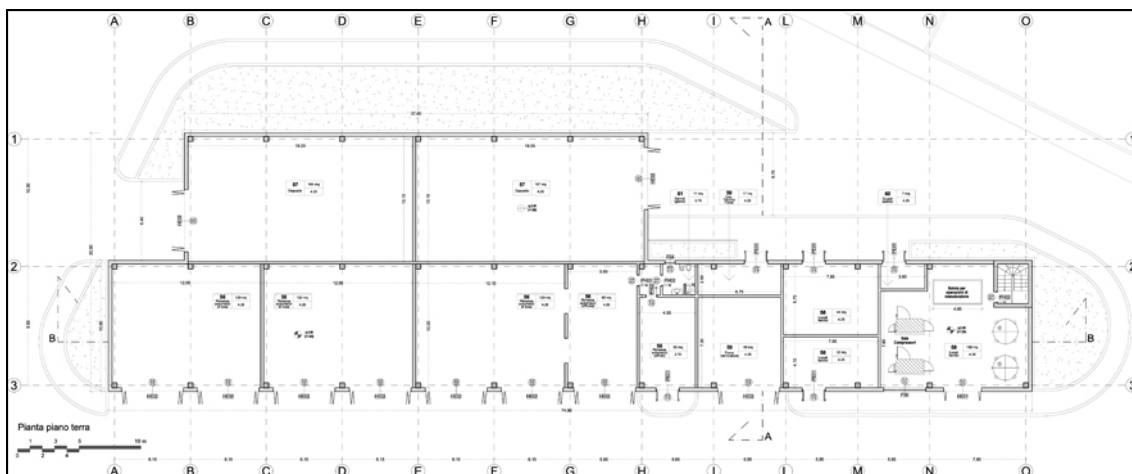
Planimetria fabbricati accessori quota +0.00 m
